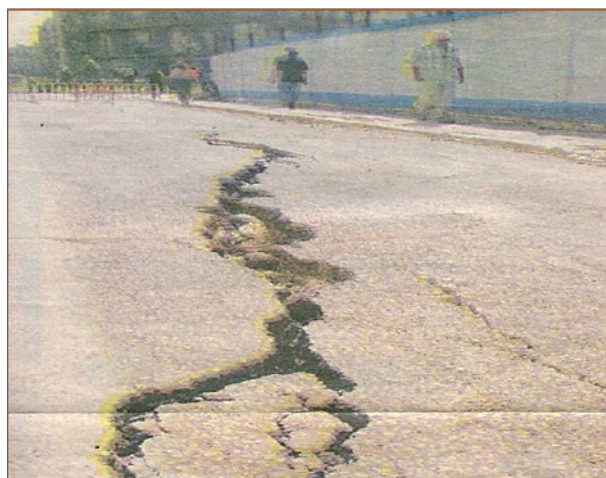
Fissuration d'un tronçon de l'avenue Boutlelis.
